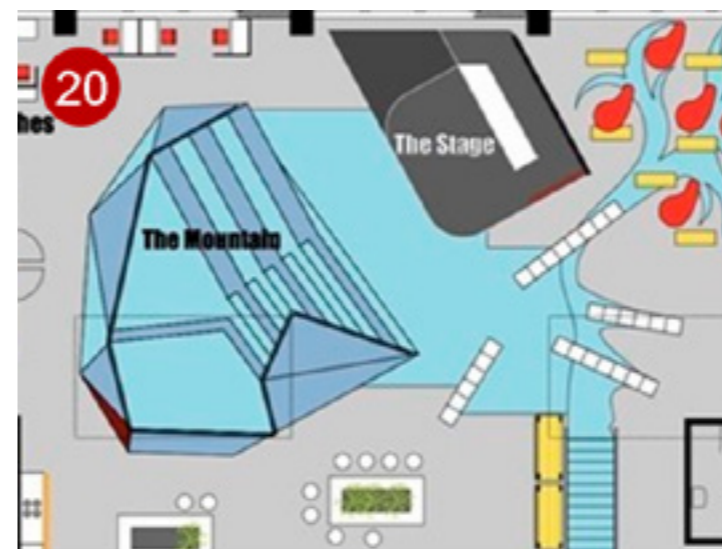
Ubicación en planta. Escuela Vittra Telefonplan – Rosan Bosch Studio.
